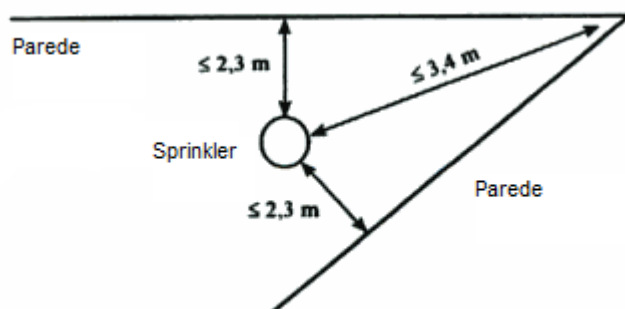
Sprinkler posicionado junto de duas paredes
